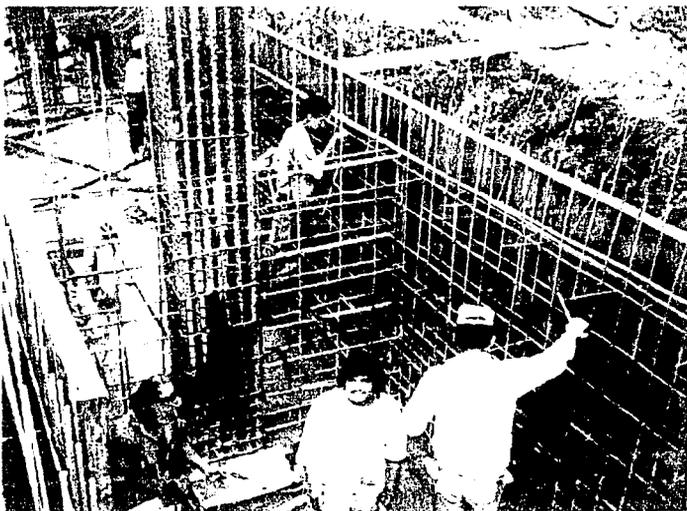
CIMENTACIÓN, EXCAVACION, PLANTILLA E INICIO DE ARMADO DE ACERO DE LAS TAPAS CORRIDAS.
